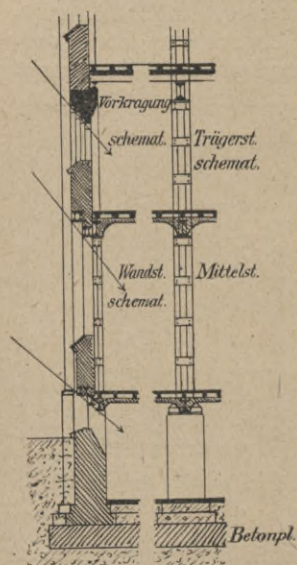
und 78. Lagerhaus kurzfrontig, eingebaut.
